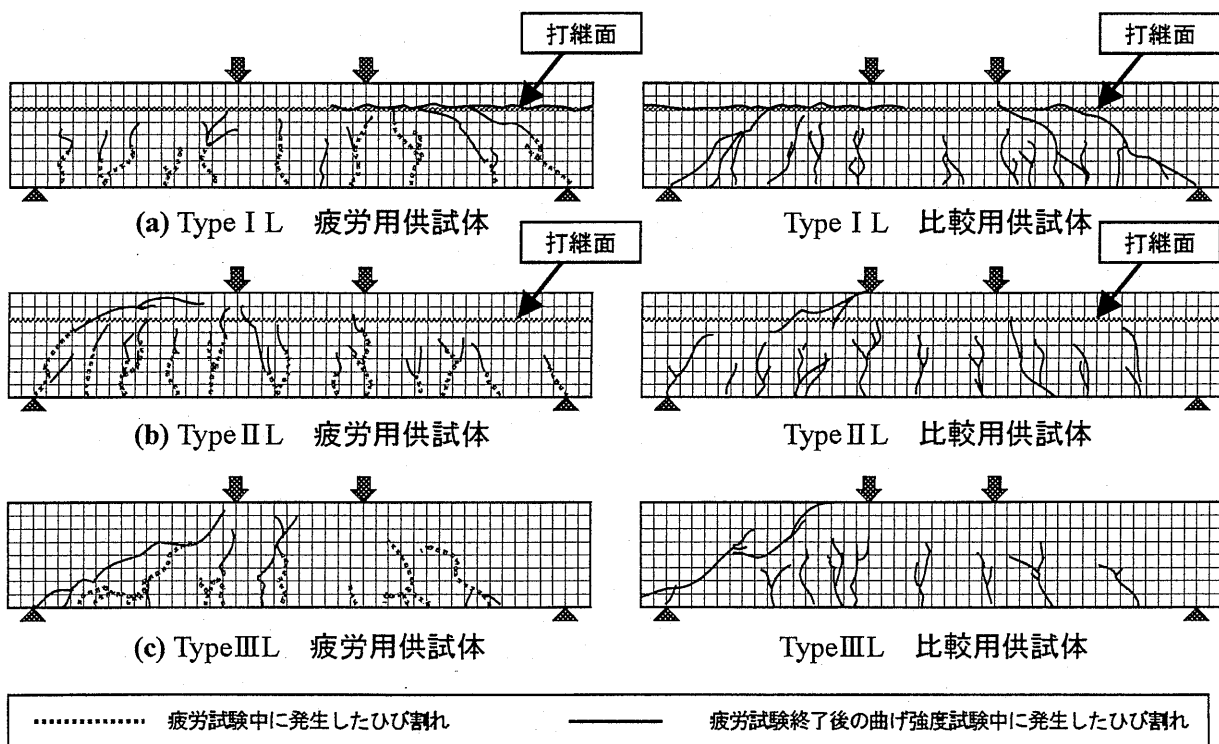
軽量骨材を用いた供試体のひび割れ図
